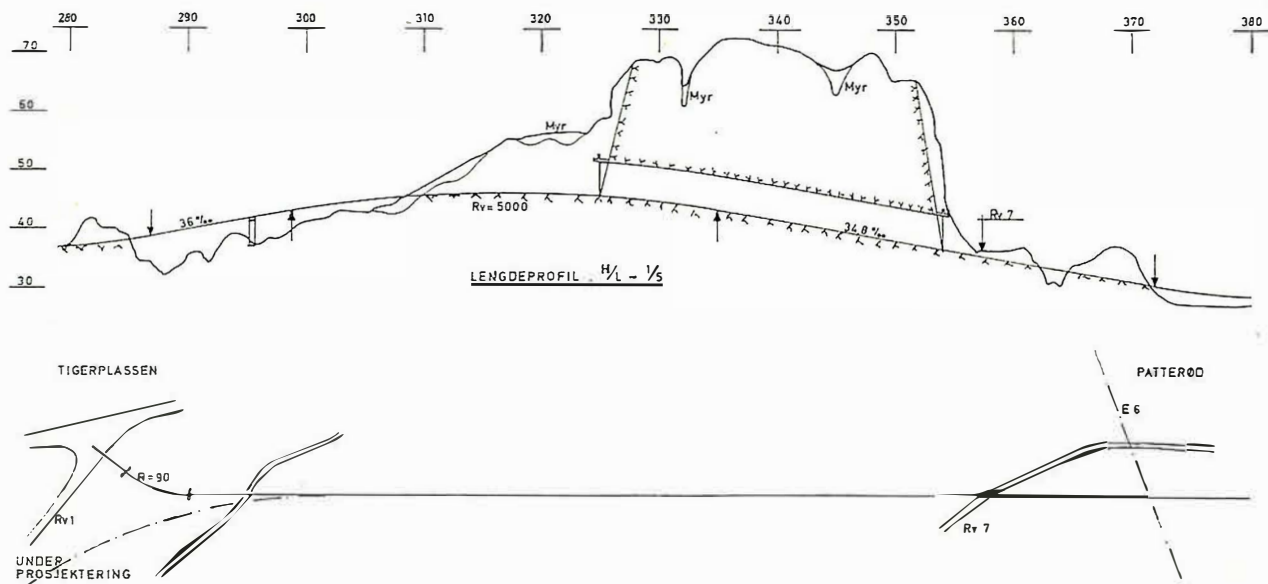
Plan og lengdeprofil av innfartsvegen med vegtunnel.
